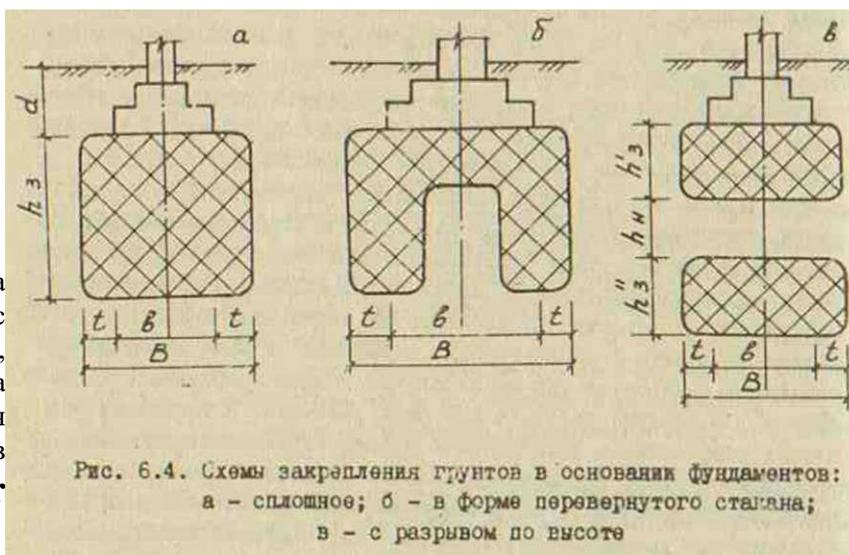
Схемы закрепления грунтов в основании фундаментов: а - сплошное; б - в форме перевернутого стакана; в - с разрывом по высоте
